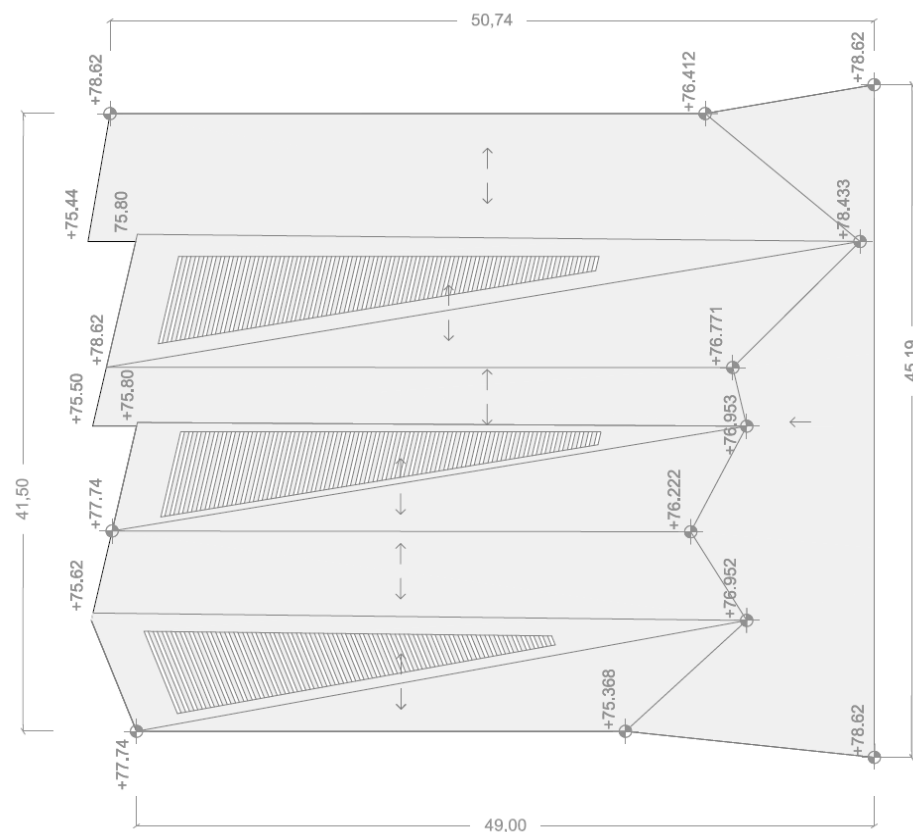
Imagen de la cubierta de la estación (PC estación de Vecindario)
